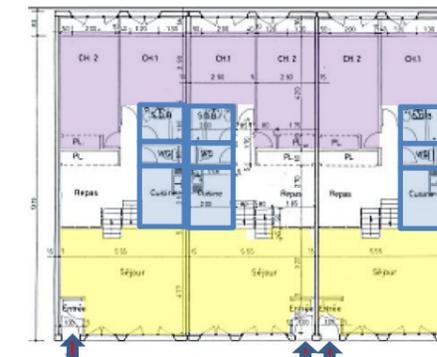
Plan 1ère étage²⁴ modifier par l'auteur
